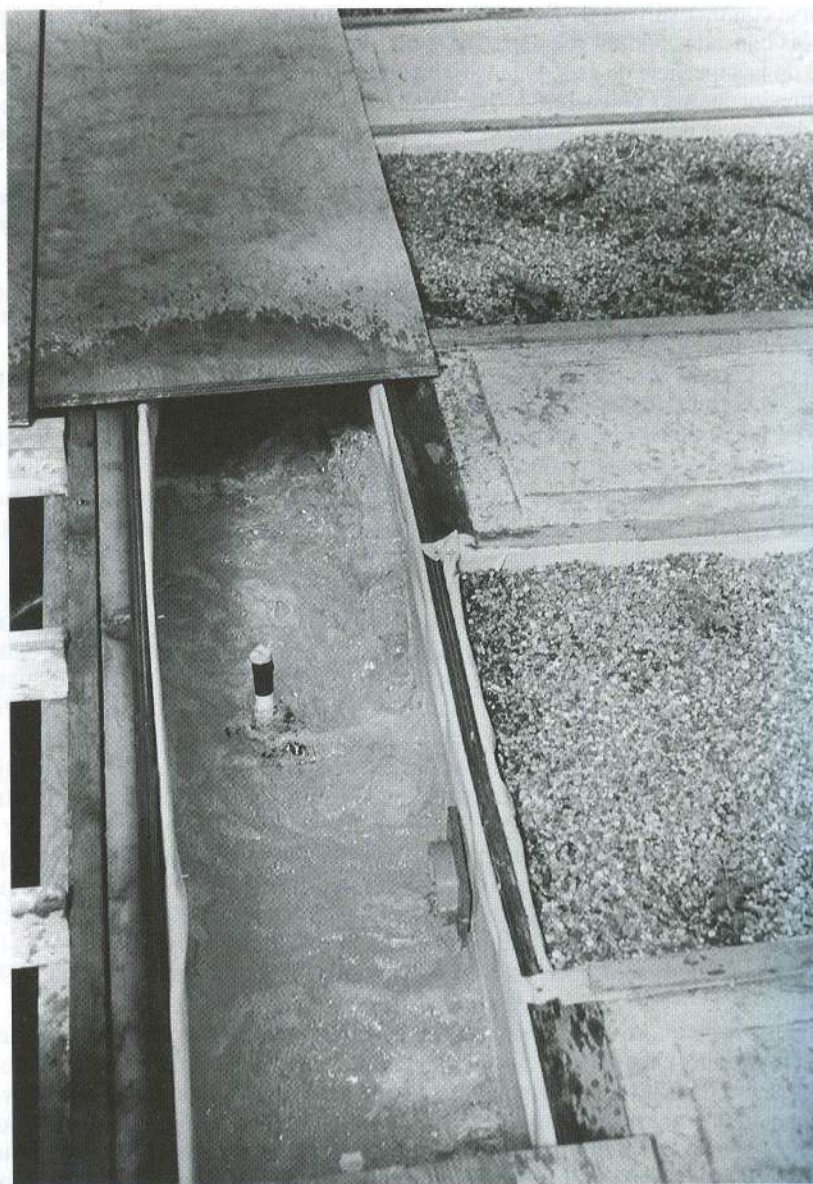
Llegada al pleno de la tubería de drenaje de la bancada.
